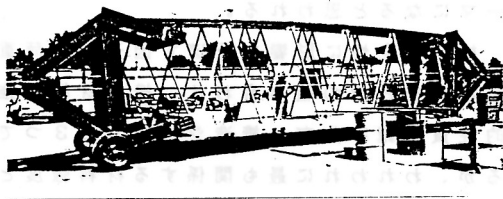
LVL flange と steel pipe latticeからなる Kibbie Dome element の座屈試験 (87)
